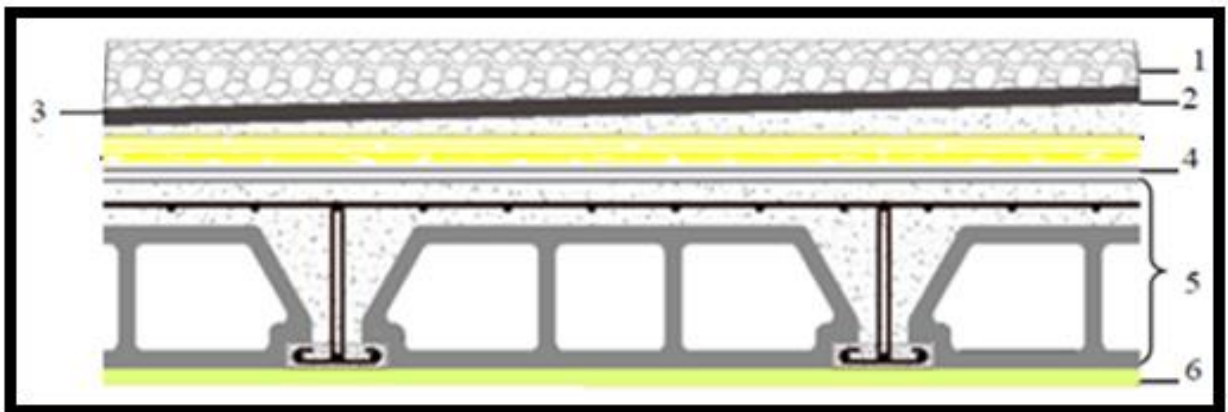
Composants d'un plancher terrasse en corps creux.
